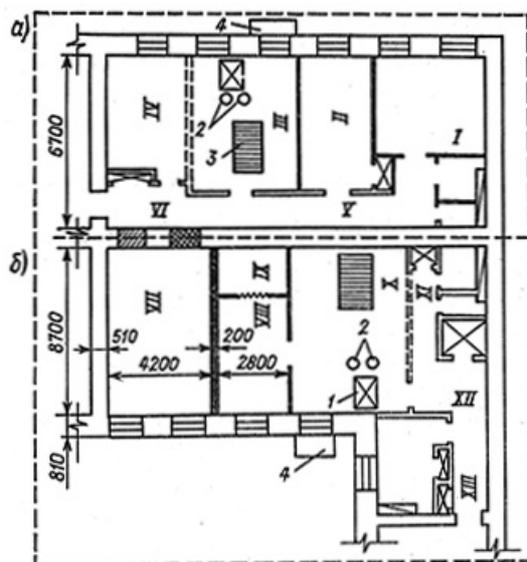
Общая схема организации работ по устройству перегородок из гипсовых плит
